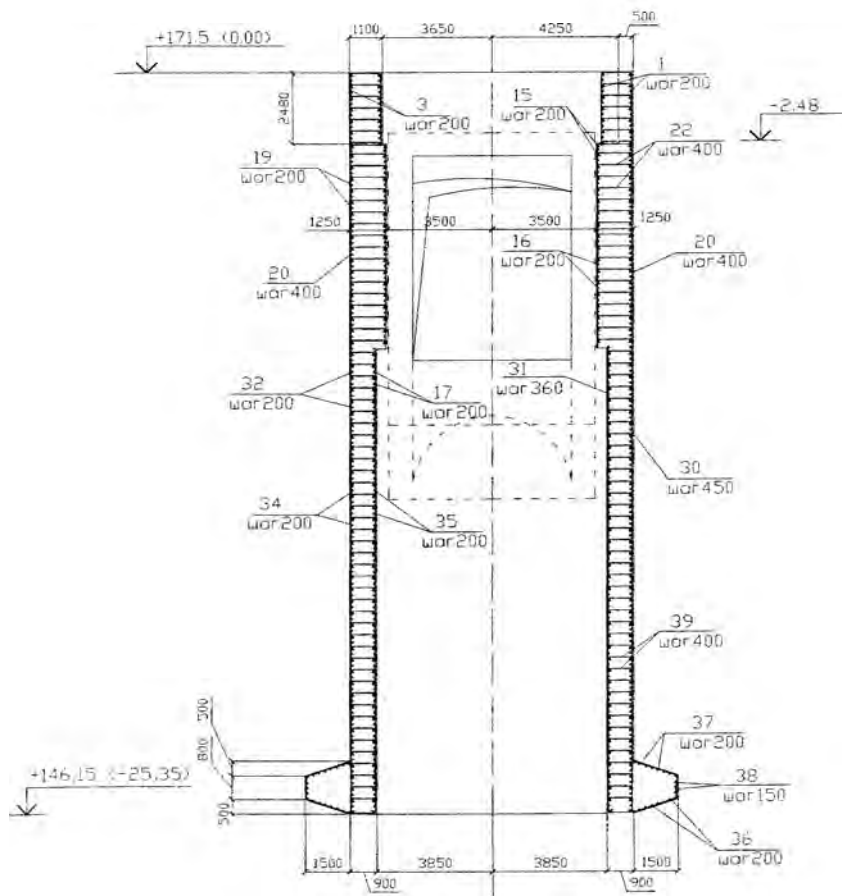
Фрагмент стыка продольных стержней устья ствола
